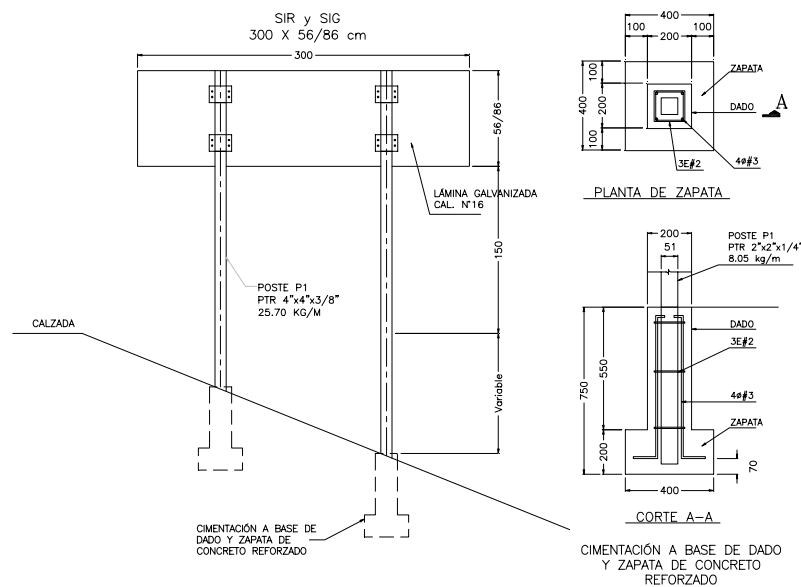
Detalle de la estructura de soporte y cimentación de las señales informativas de recomendación y general (SIR y SIG).
